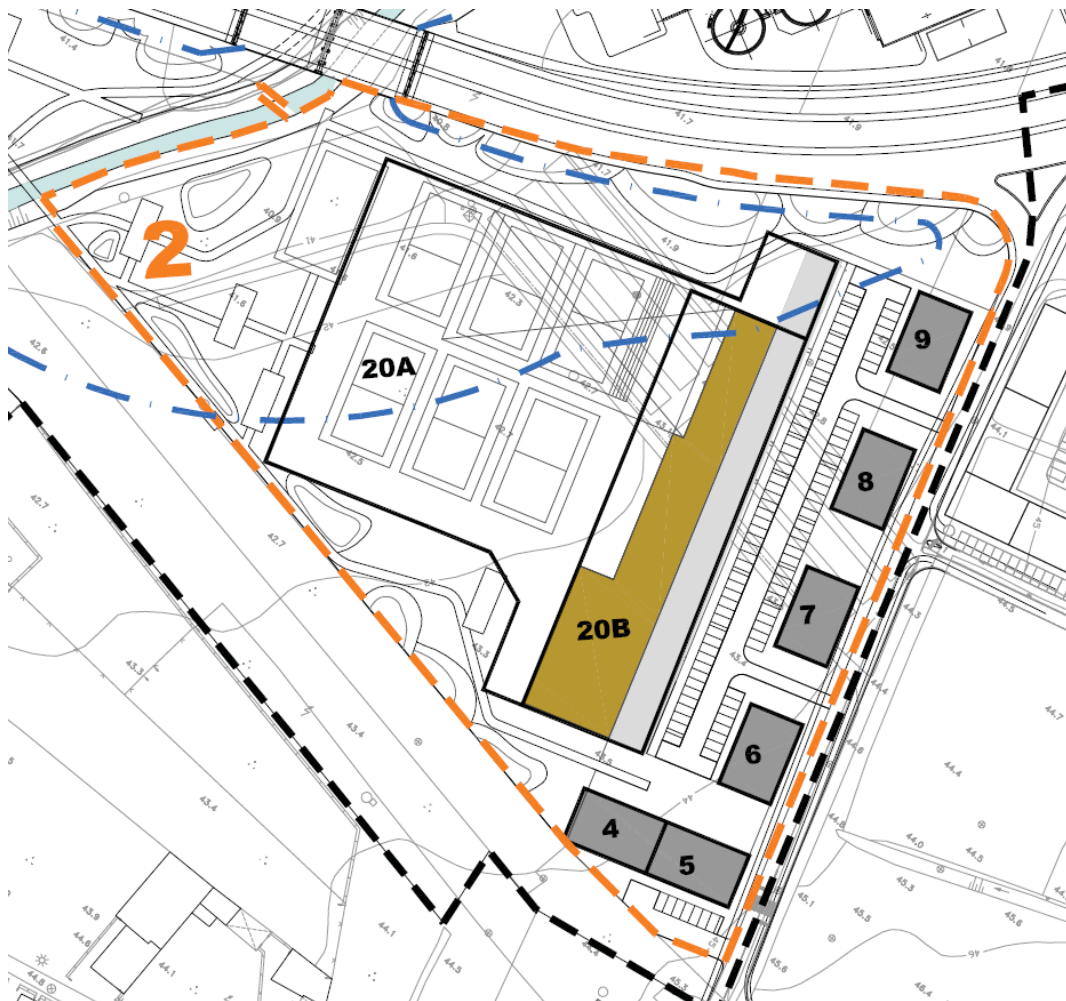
Excerto Plano de Pormenor Olhalvas e São Romão
